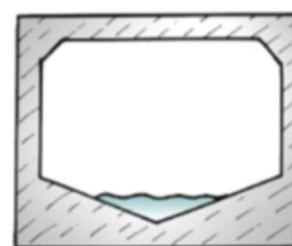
Prefab duiker met betonnen loopstroken.
